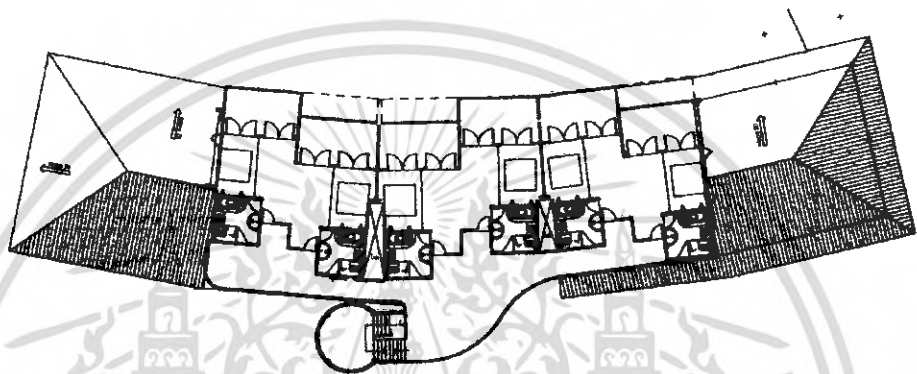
แสดงแปลนอาคารห้องพักแบบ Sea view Deluxe Building ชั้นที่ 1
